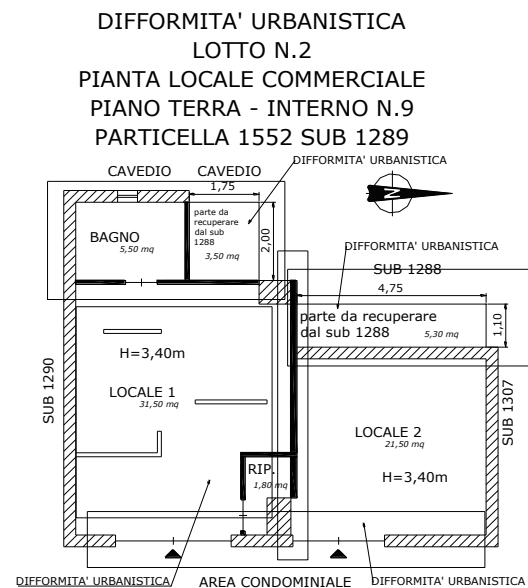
planimetria delle difformità urbanistiche del locale commerciale pignorato al piano terra
